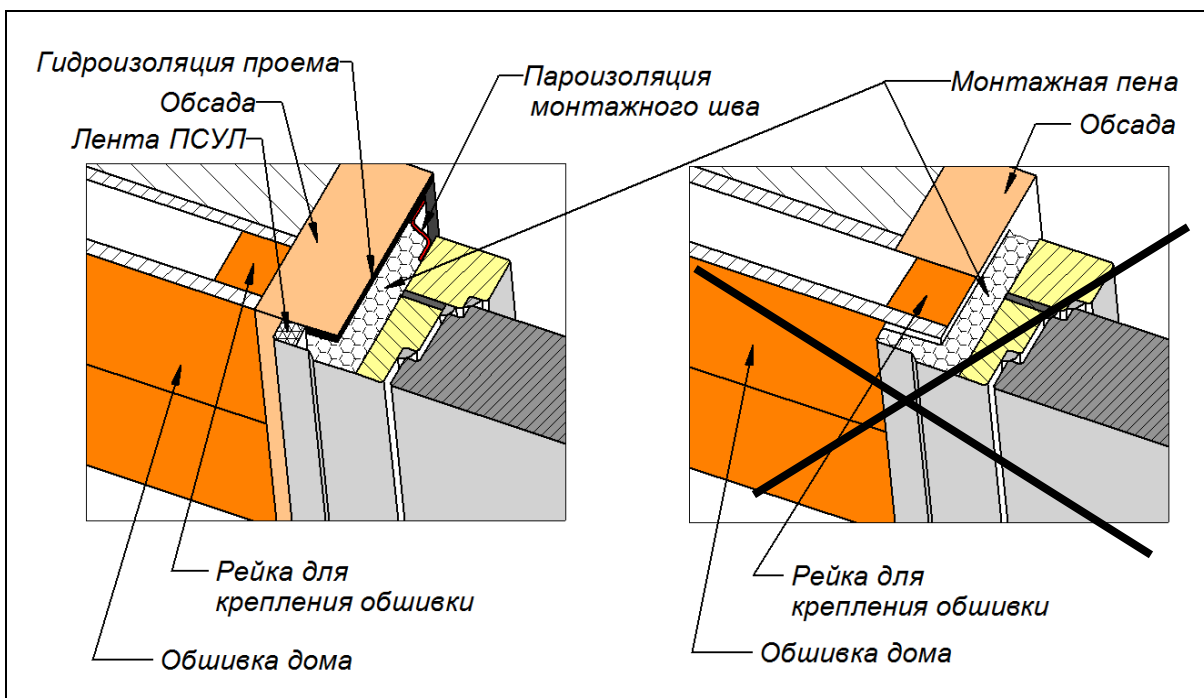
Схема ПРАВИЛЬНОГО монтажа дверного блока в проеме каркасного дома (Выполнена гидроизоляция проема, наклеена лента ПСУЛ по периметру наличника, выполнена пароизоляция монтажного шва)
